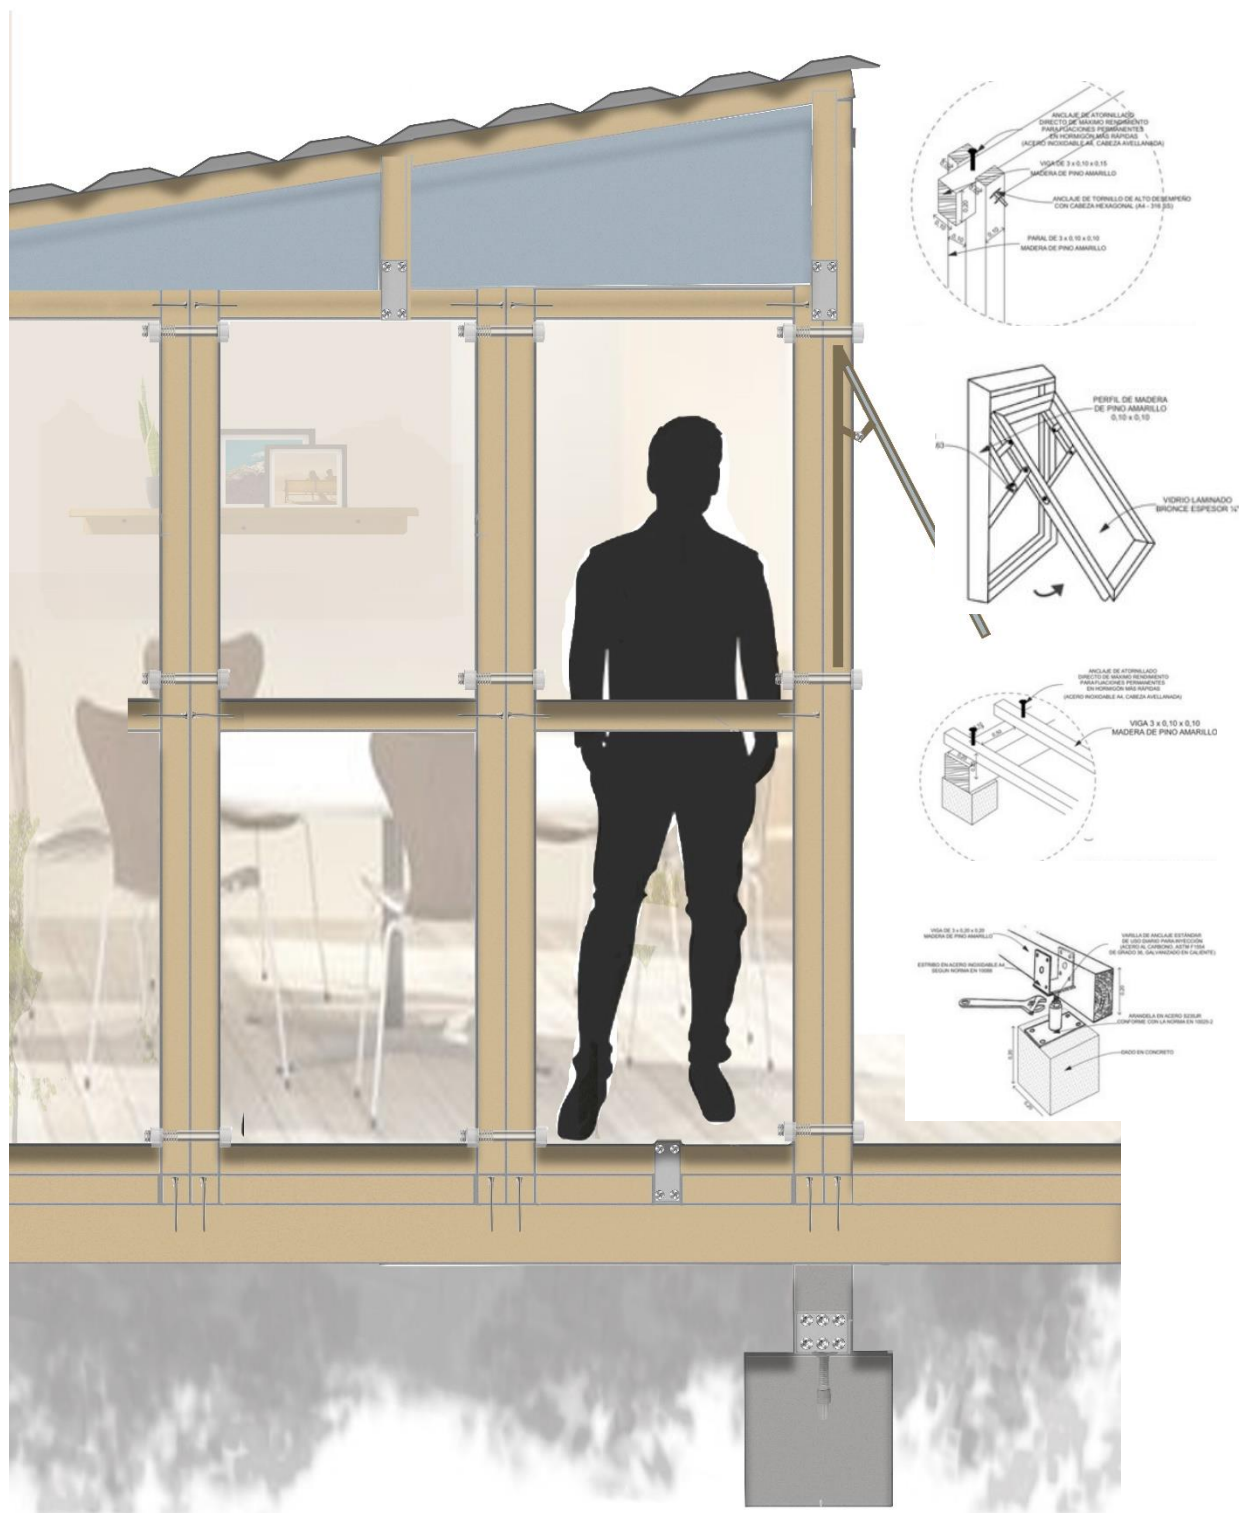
Corte Fachada - Fuente: Elaboración Propia 2020
